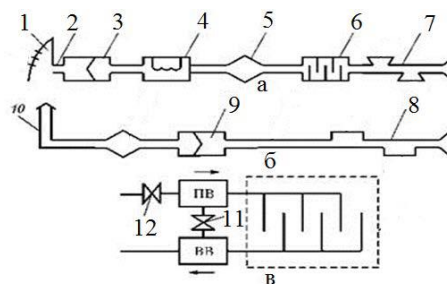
Схеми загальнообмінної механічної вентиляції: а – припливна вентиляція (ПВ); б – витяжна вентиляція (ВВ); в – припливно-витяжна вентиляція з рециркуляцією; 1 – повітрозабірний пристрій; 2 – повітропроводи; 3 – фільтр; 4 – калорифер; 5 – вентилятор; 6 – зволожувач-осушувач; 7 – повітророзподільник; 8 – повітроприймачі; 9 – апарат очищення повітря; 10 – розсіювач; 11,12 – регулювальні клапани.
